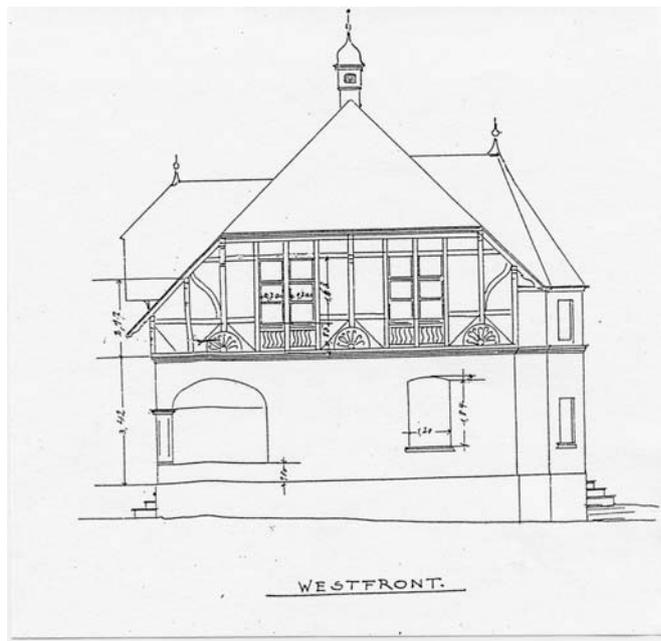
Sommerhaus H. Plange, Aufriss der Westfassade, 1898
